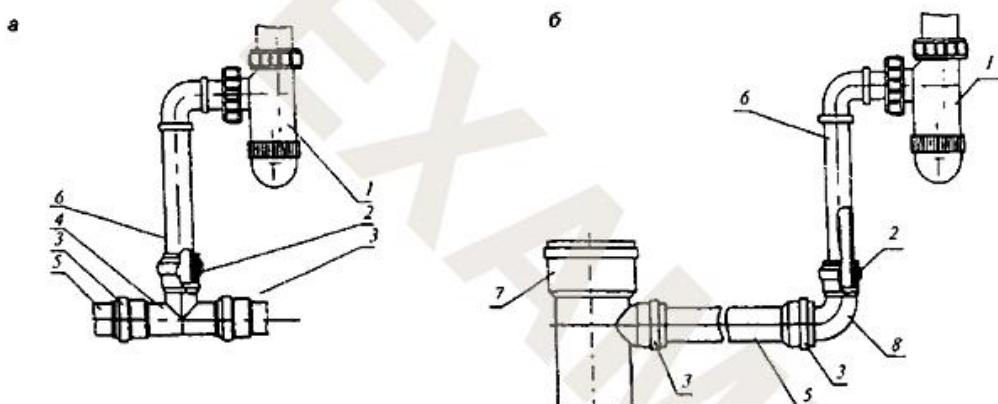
Соединения отводных труб пластмассовых сифонов с трубопроводами
